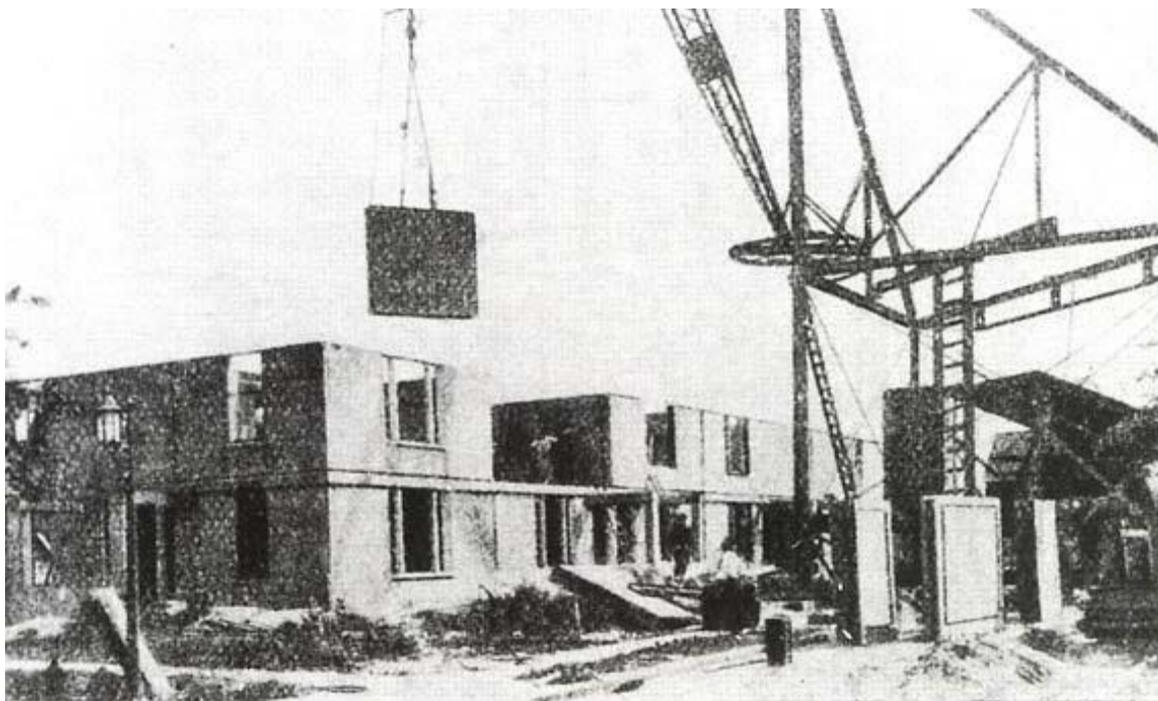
Монтаж экспериментального бетонного дома Г. Аттербери
